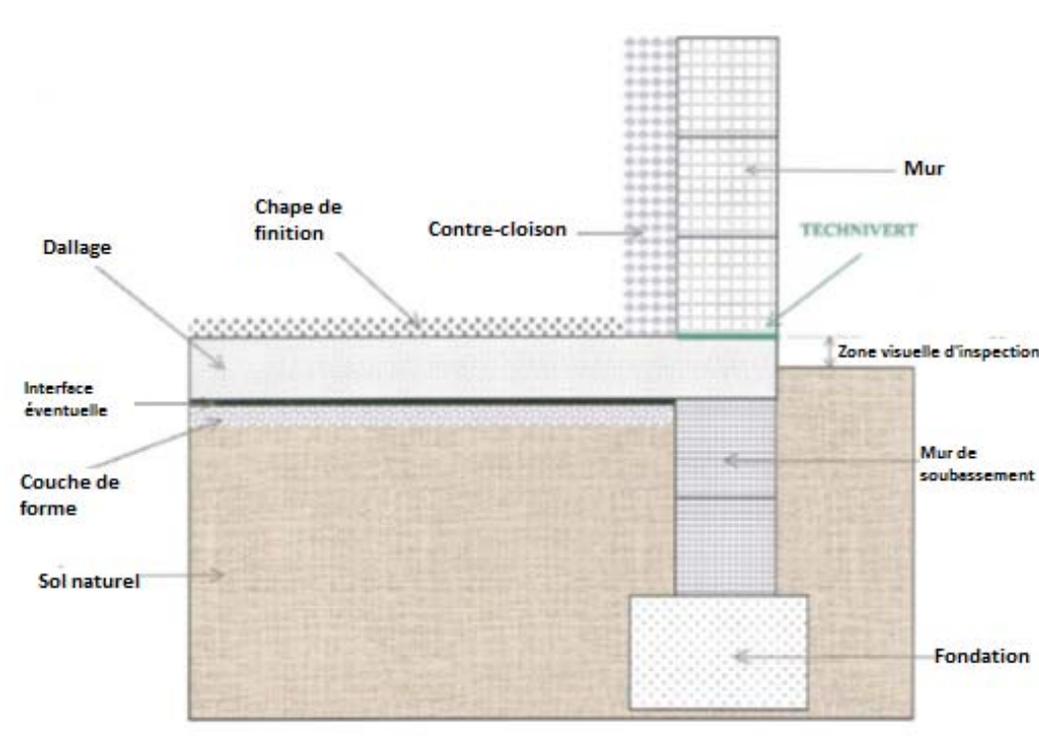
Coupe sur dallage (réalisé suivant le DTU 13.3)
